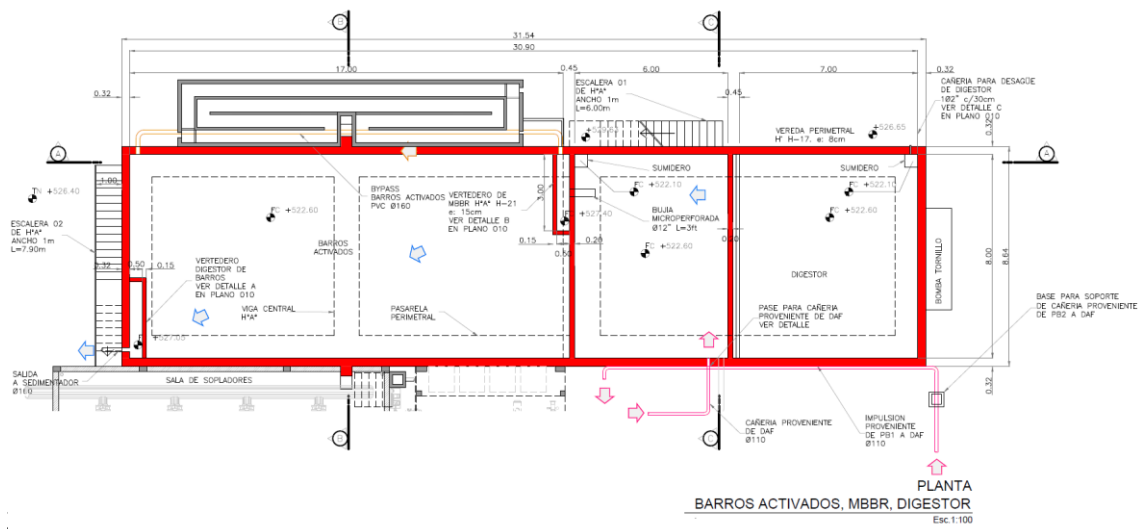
Planta de estructura para Barros activados, MBBR y Digestor
